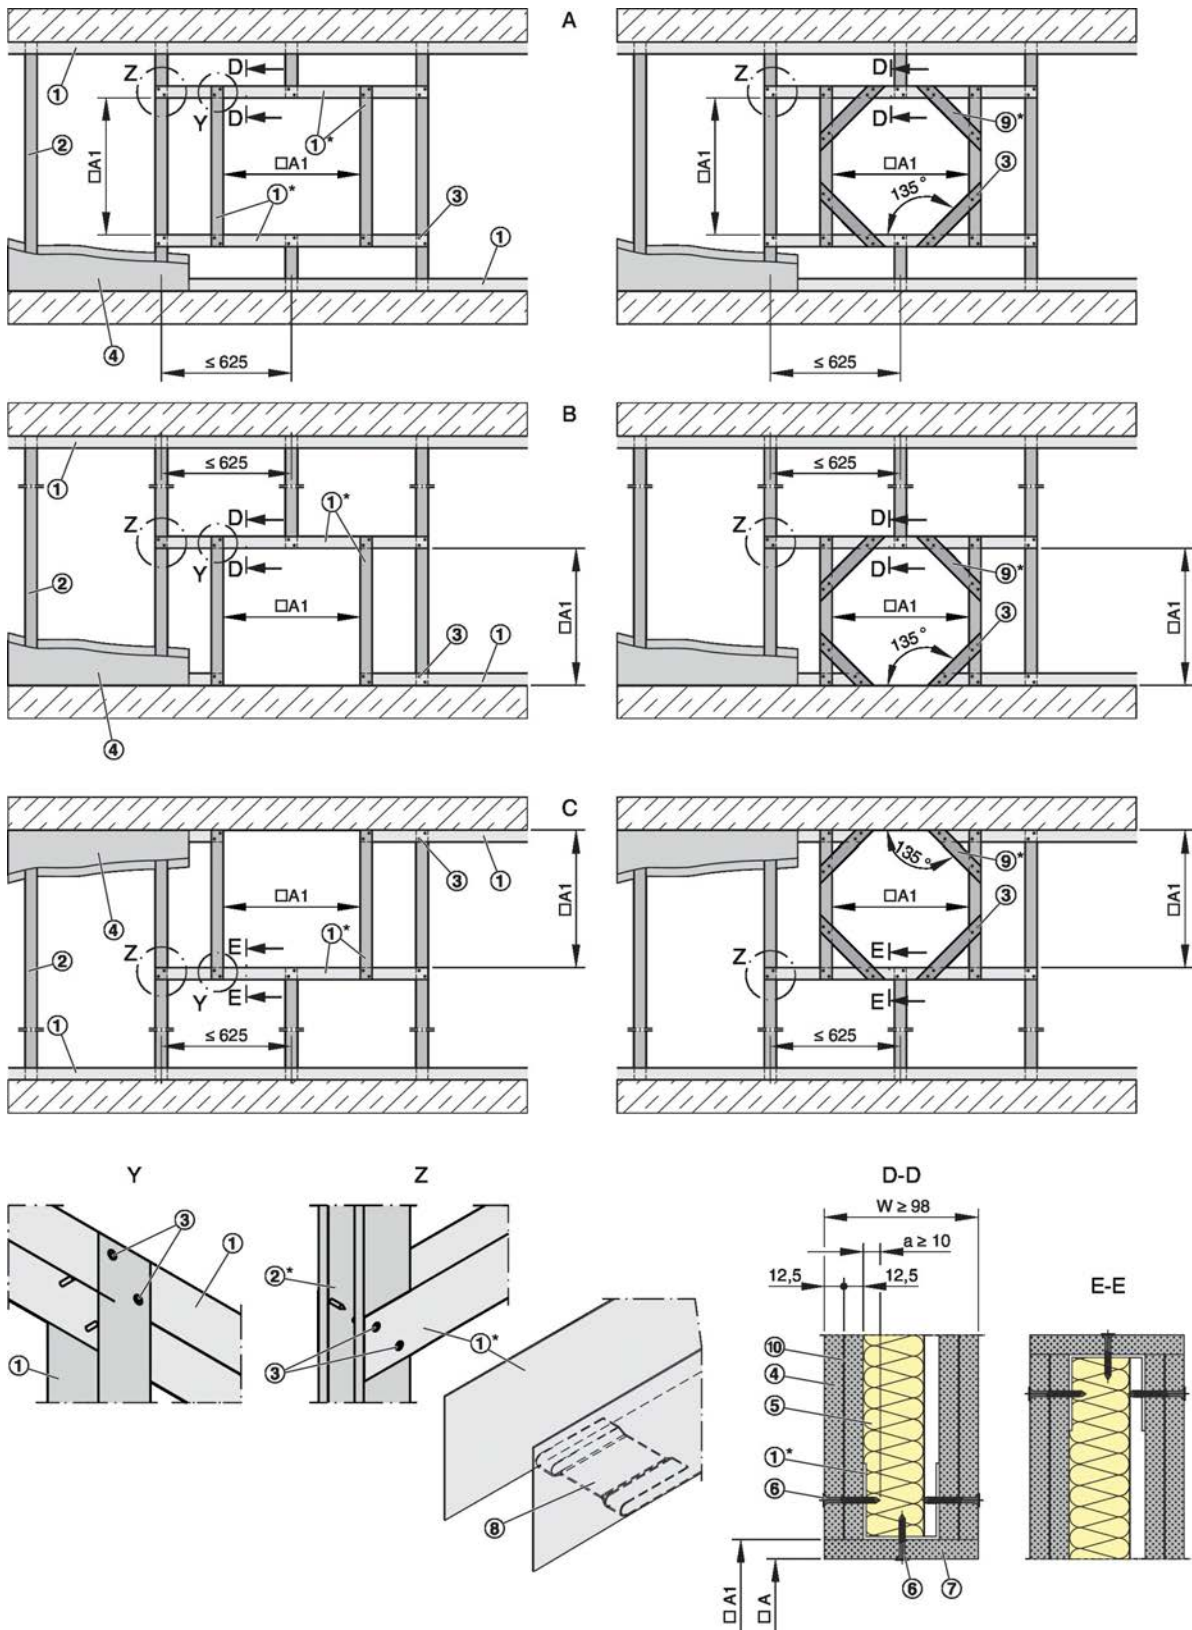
Pared ligera con estructura metálica y aislamiento a ambos lados
